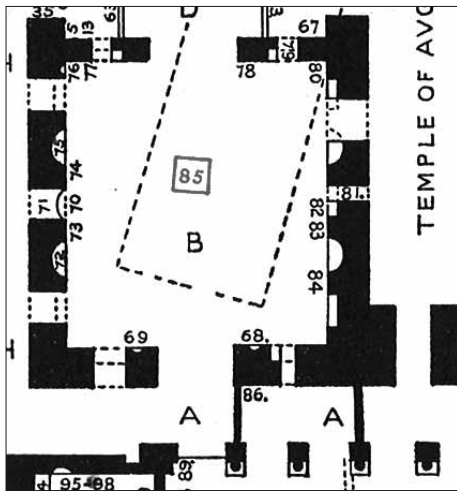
/6 Grundriss des Atriums mit Markierung des von Giacomo Boni zerstörten Pfeilers (Detail aus dem Plan von Rushforth).
